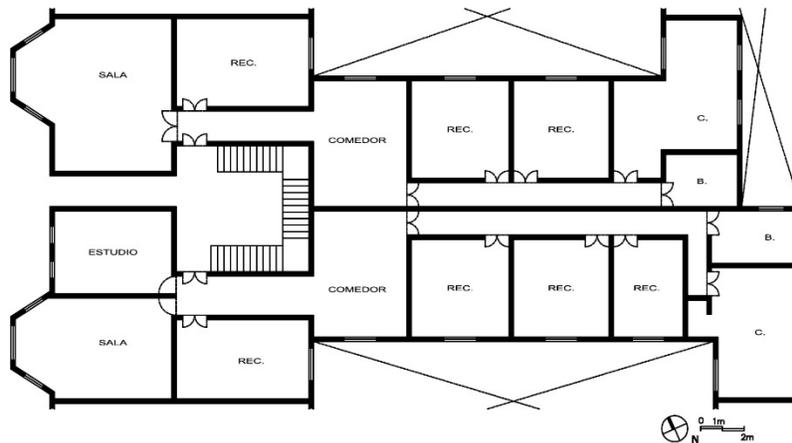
Planta de un apartamento tipo del edificio ubicado en Versalles núm. 106-110.
